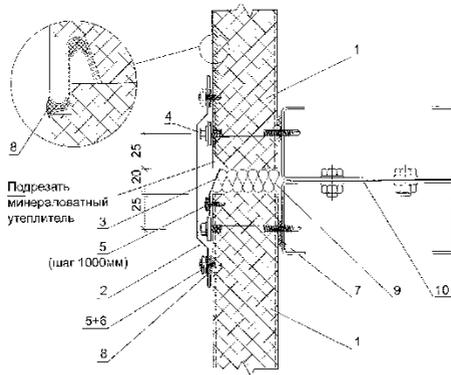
Крепление стеновых панелей при вертикальной разрезке стен к ригелям:
